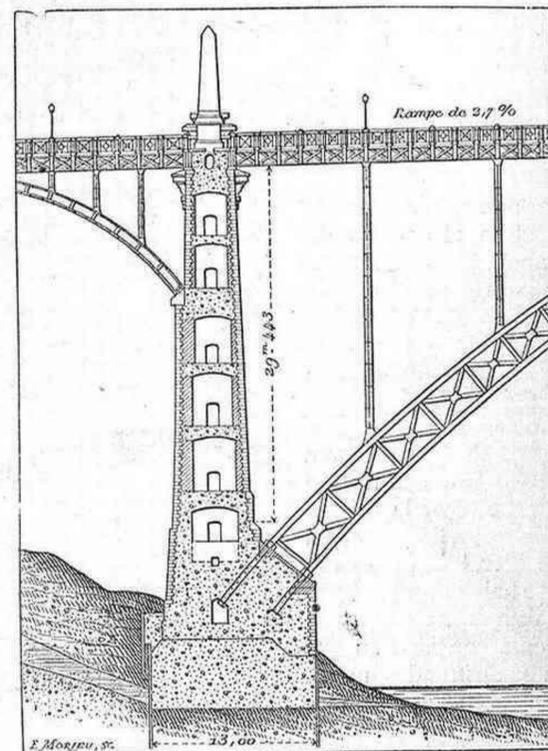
Sección longitudinal de una de las pilas del puente de Kornhaus
